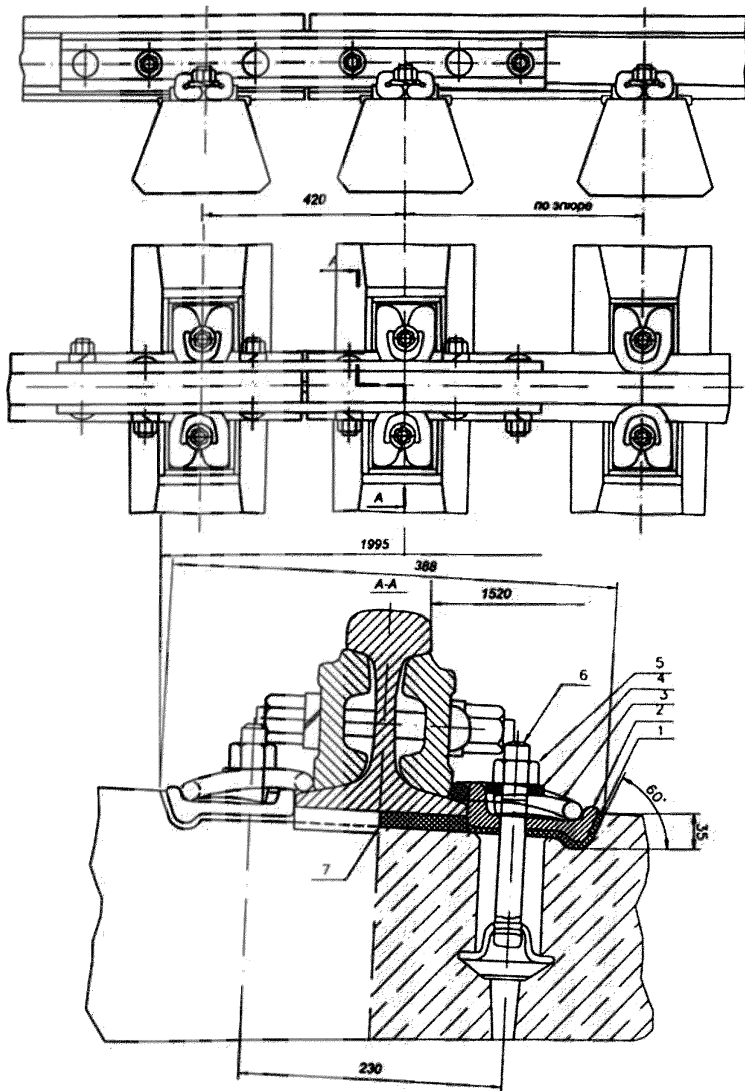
Стыковое и промежуточное крепление ЖБР-65 на железобетонных шпалах с рельсами Р65:
